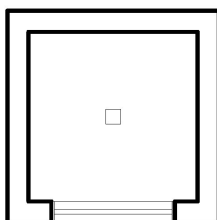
Planta baixa esquemática das células-teste escala 1/50
